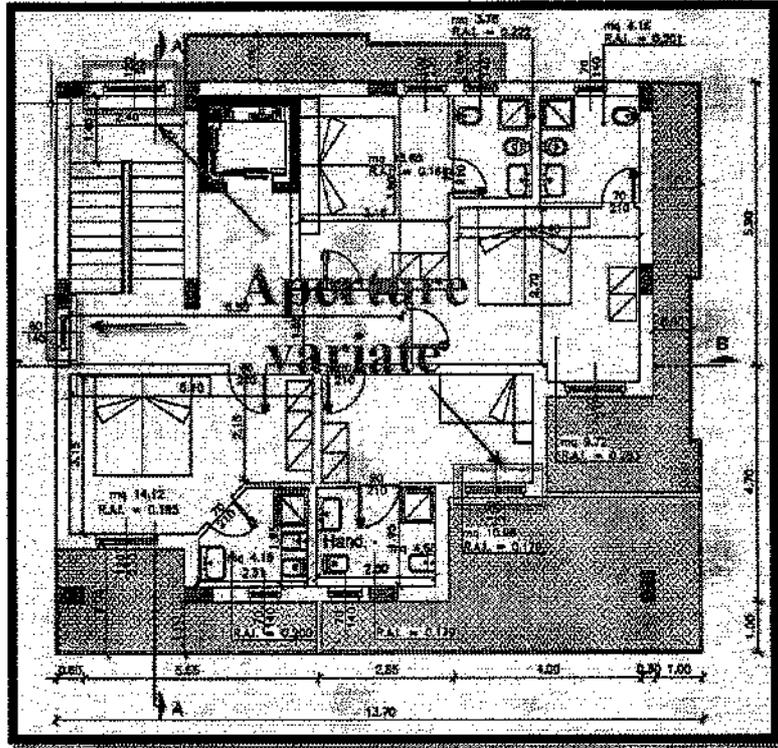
Pianta piano secondo allegata alla D.L.A. prot. 1461 del 13/02/2008
